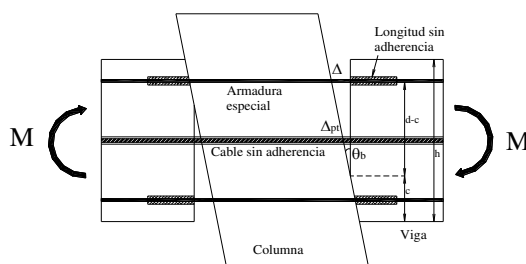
Mecanismo de abertura en la interfase viga-columna (Fuente: Fuente Bonelli y Holmberg, 2004)
